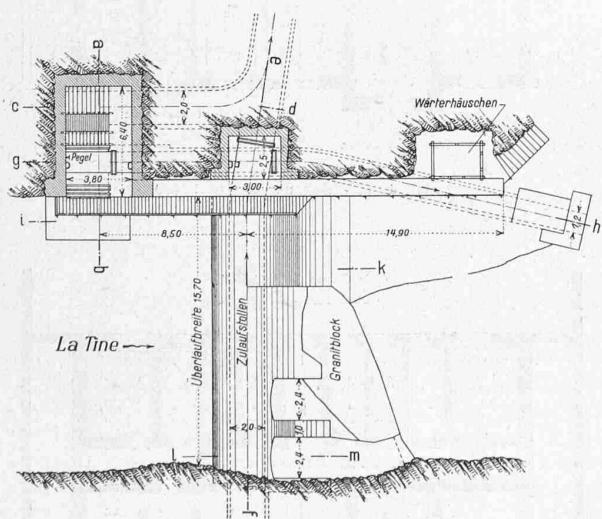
Wasserfassung der Tine. — Grundriss 1 : 400.
